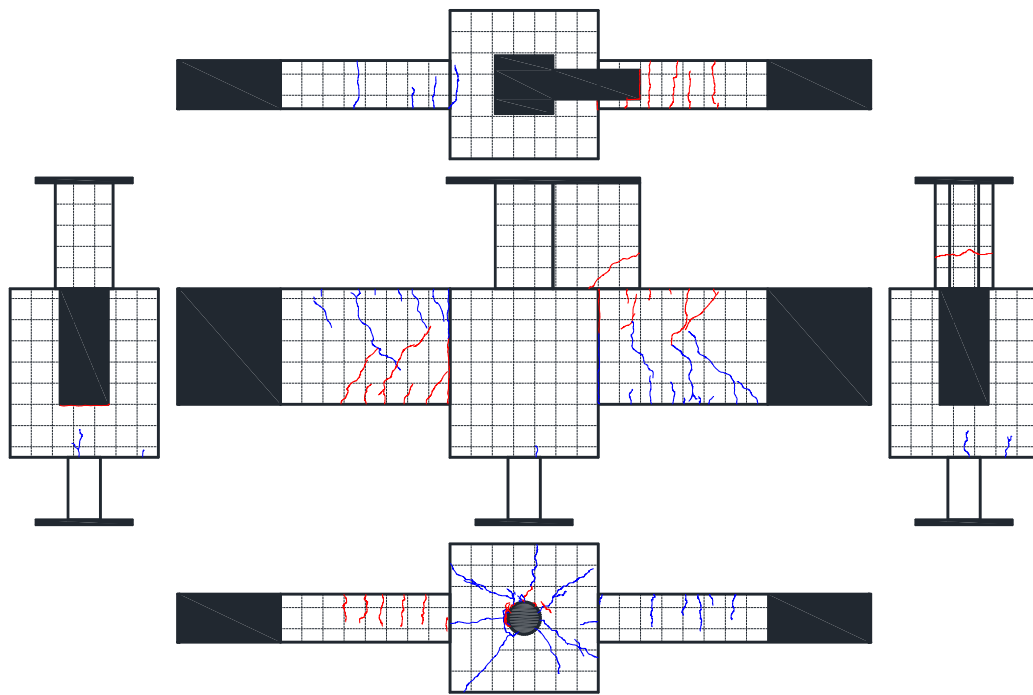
2. 3-56 試験体 DR-5 ひび割れ状況 (3Cycle)
